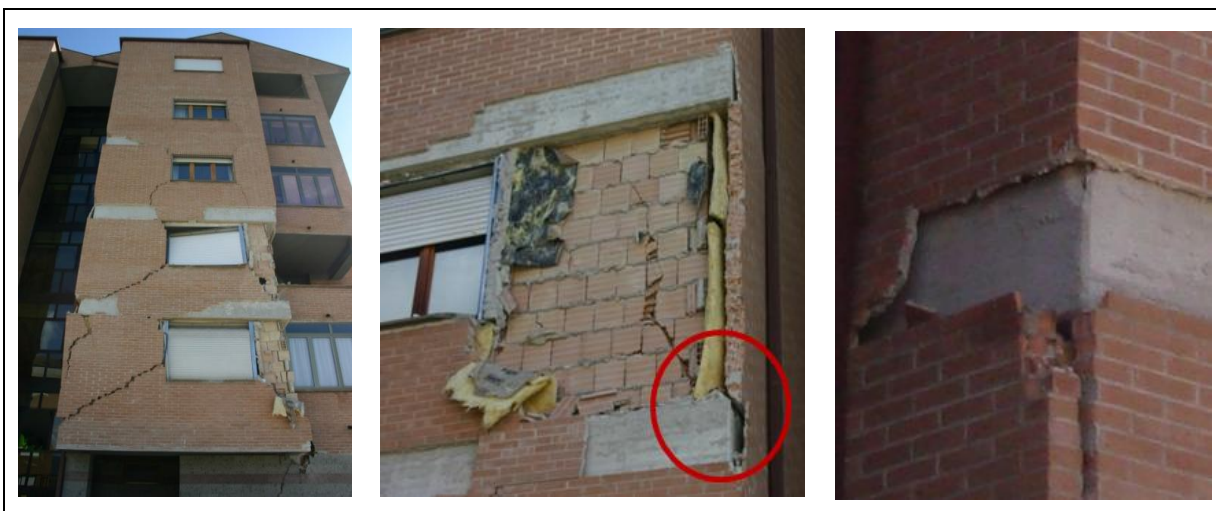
Fissuração e colapso da parede exterior do pano exterior da parede dupla
